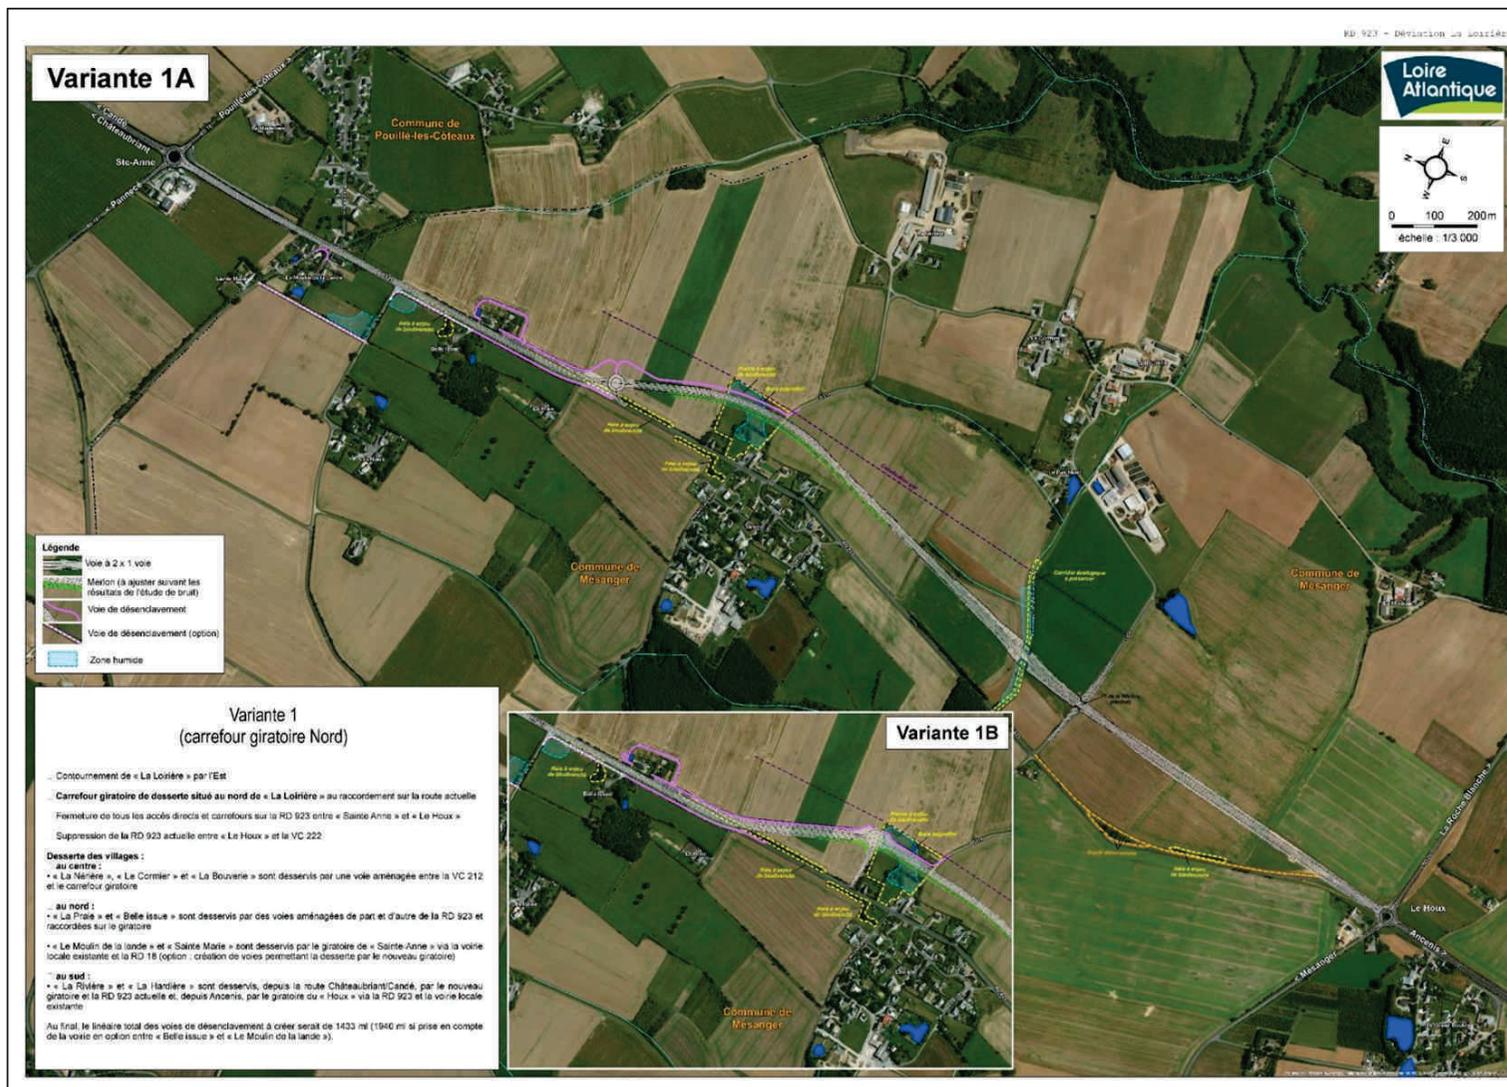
Variante1A : Positionnement à hauteur du point de raccordement de la déviation sur la route actuelle
